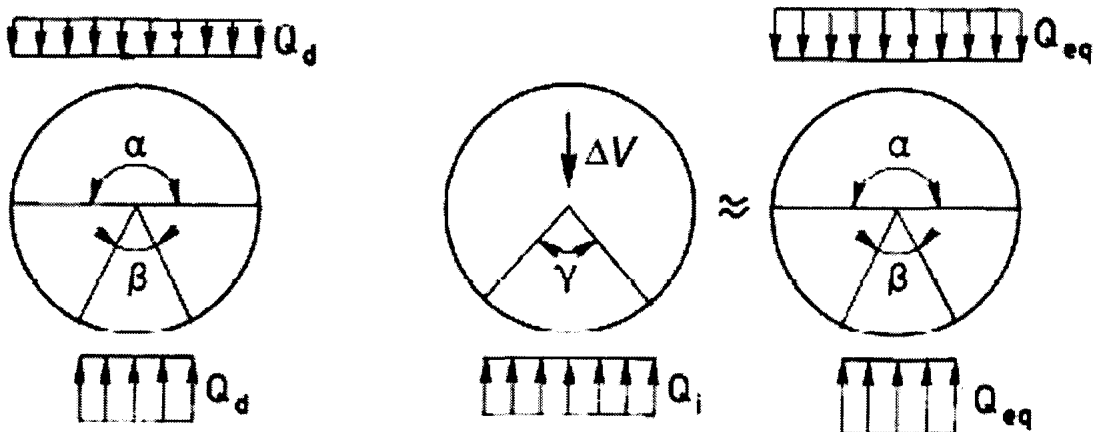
Навантаження ґрунту Q_d , Q_i і Q_{eq} , що впливають на поперечний переріз трубопроводу
